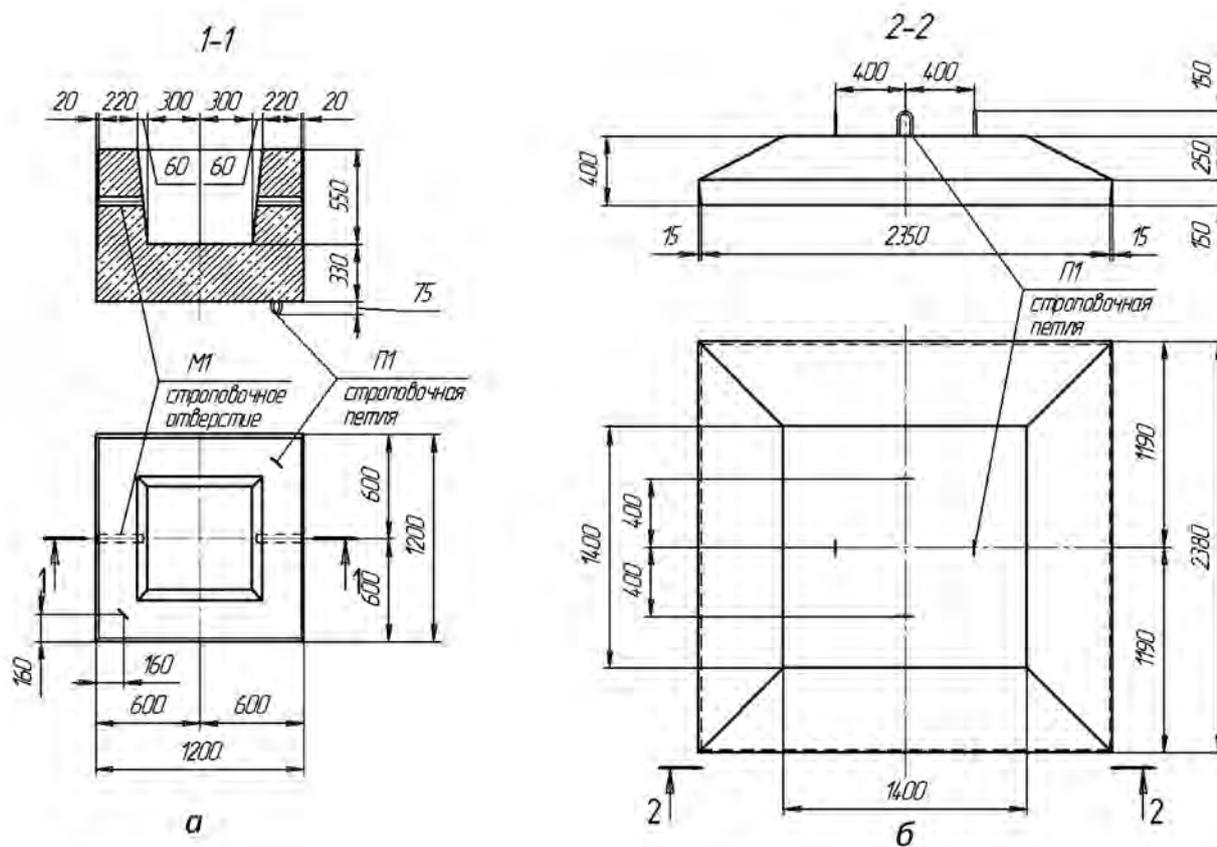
Опалубочные чертежи: *a* — башмак под колонну 1БК6-12-9; *б* — фундаментная плита ФП24. 24-25 по территориальному каталогу типовых изделий для строительства в г. Москве
